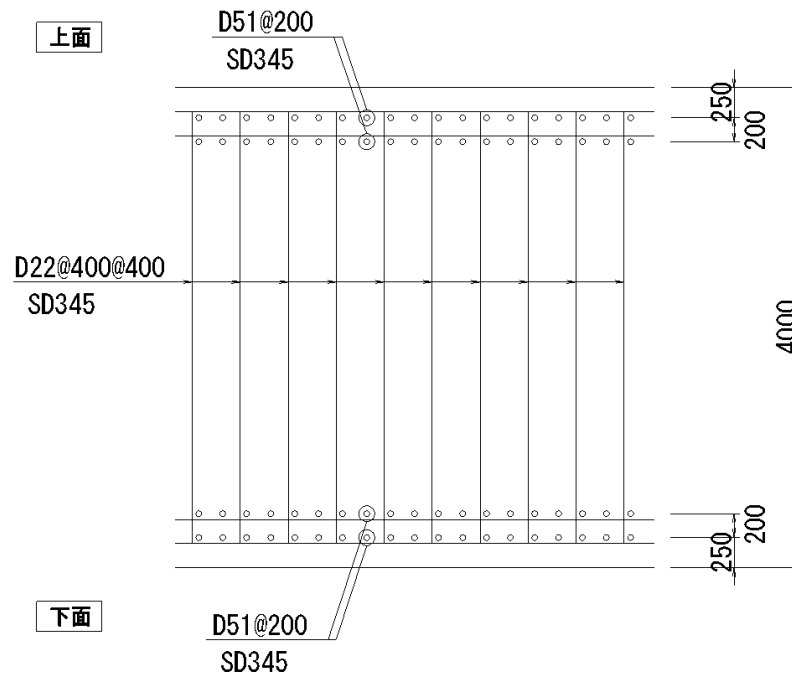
(2) 漂流物対策工基礎スラブの概略配筋図
